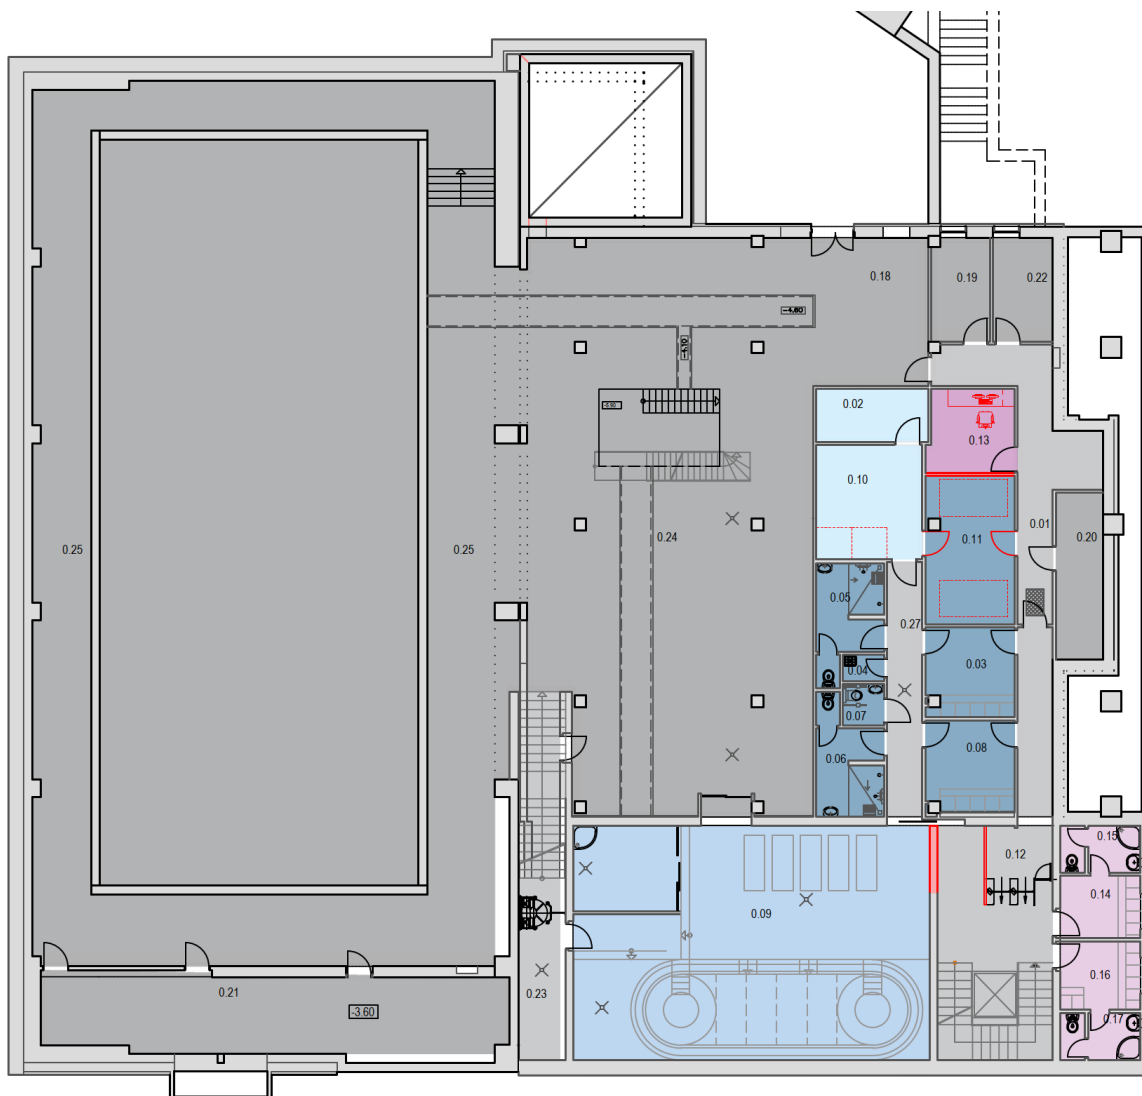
Půdorys finálního stavu 1.NP (zdroj Aprotia.)
